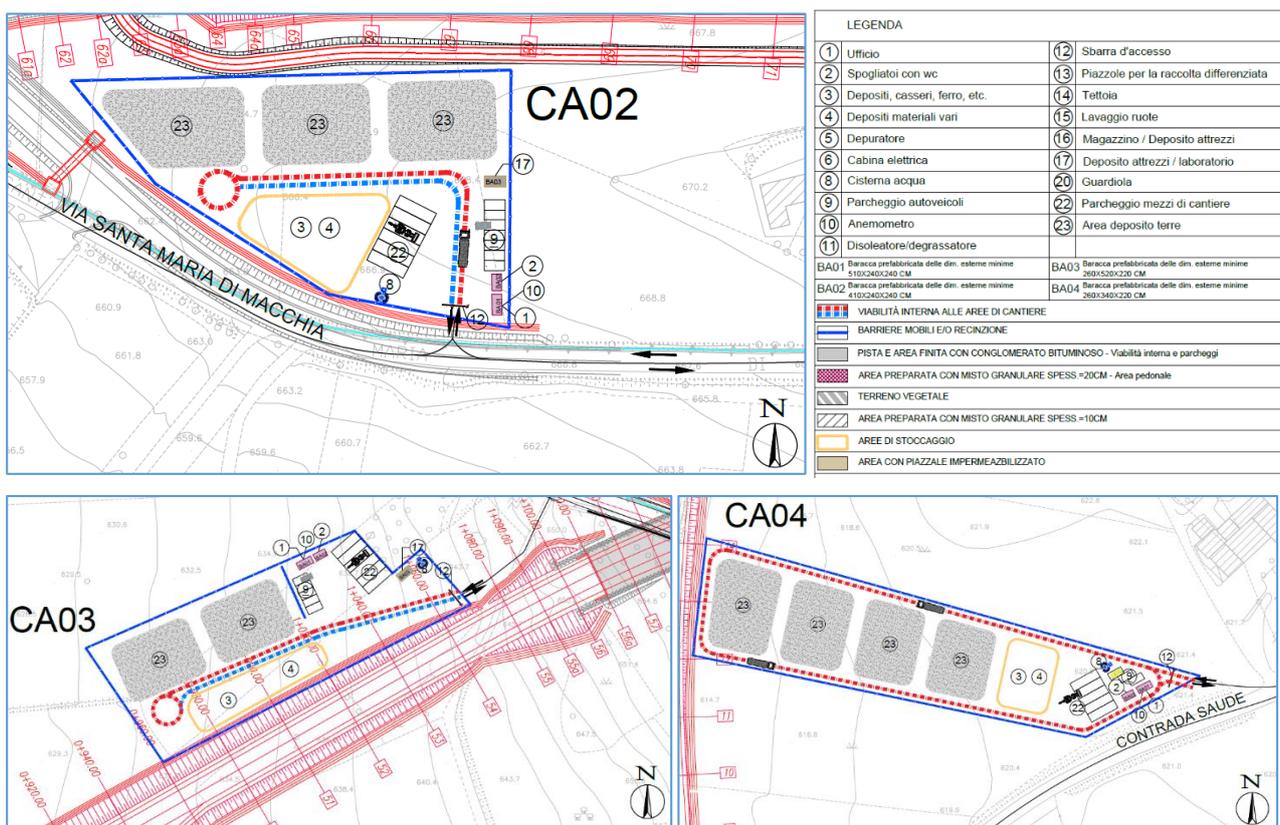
Planimetria di cantiere CA02 - CA03 - CA04
